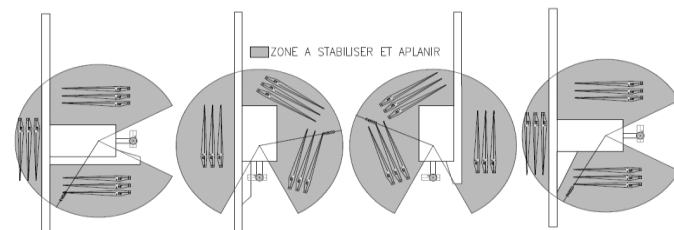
& tableau 2 : Exemples de stockages et dimensions
